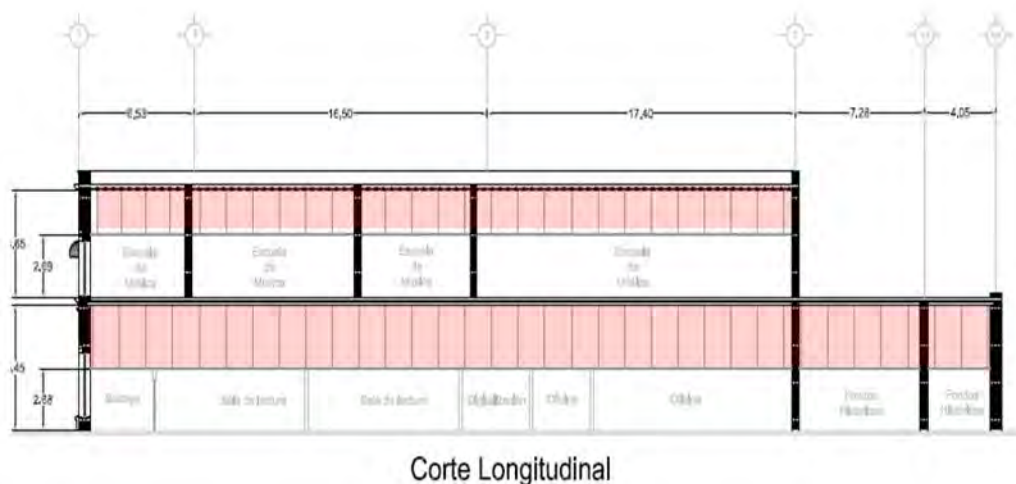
Corte longitudinal del AHGES, mostrando en rojo el espacio perdido por el uso del falso plafón en ambas plantas
